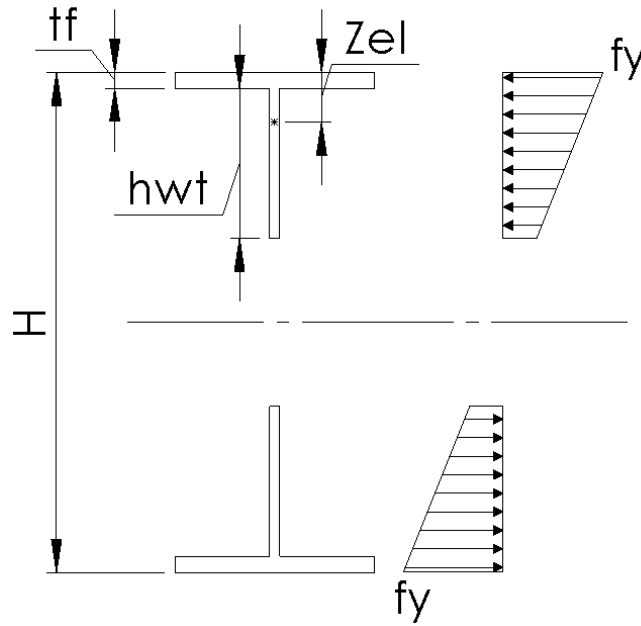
Distribuição elástica de tensões na secção transversal da viga alveolar.
